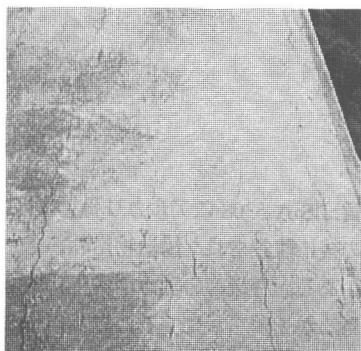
橋軸方向のひび割れ(事例ア)
